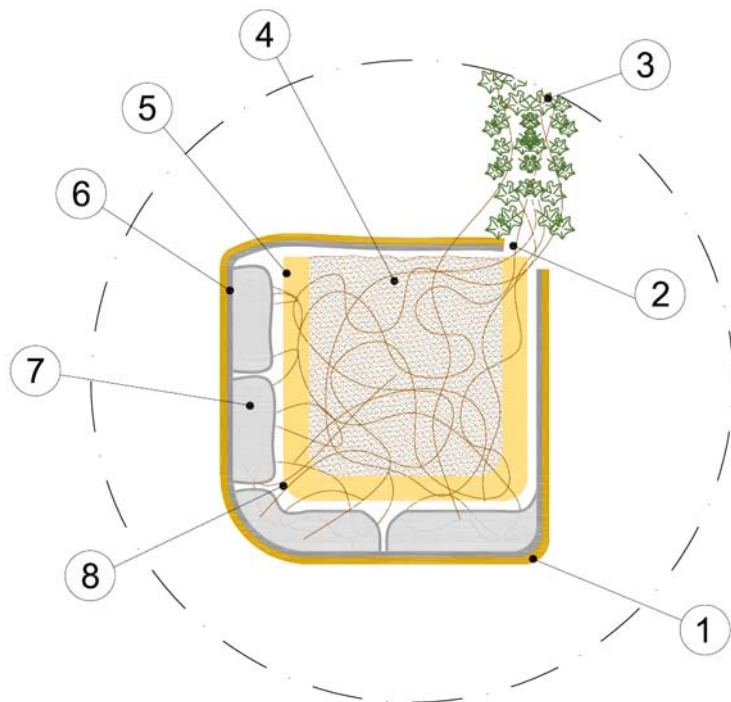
Sezione schematica della struttura di radicamento delle rampicanti
